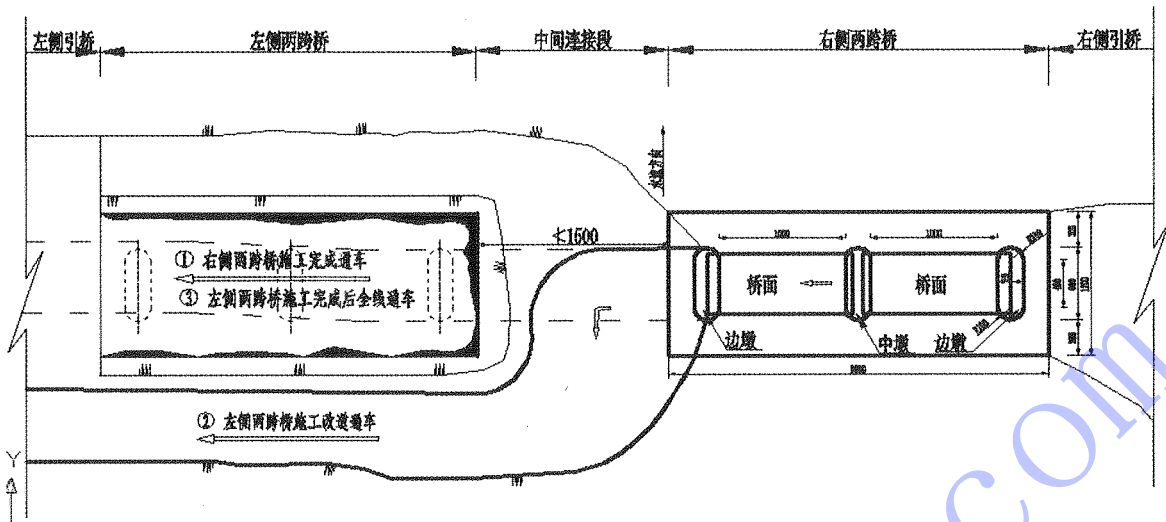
沙尔布拉克水电站钢架桥施工顺序示意图(单位:cm)
